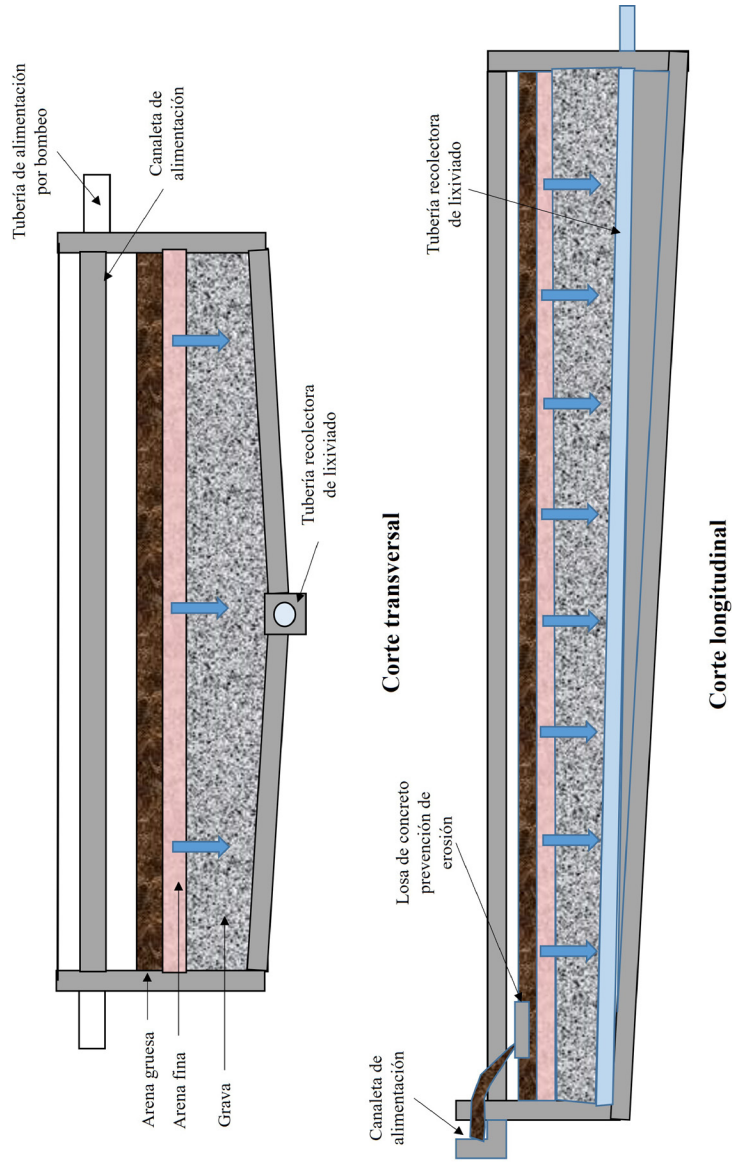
Corte longitudinal y corte transversal del lecho de secado.
